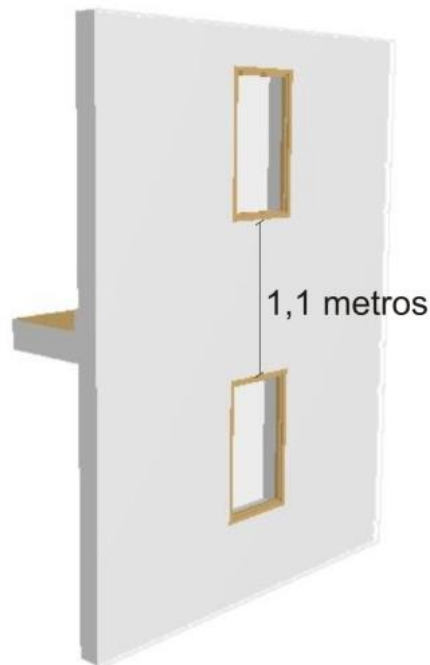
Distância entre vãos de fachada sucessivos sem obstrução
